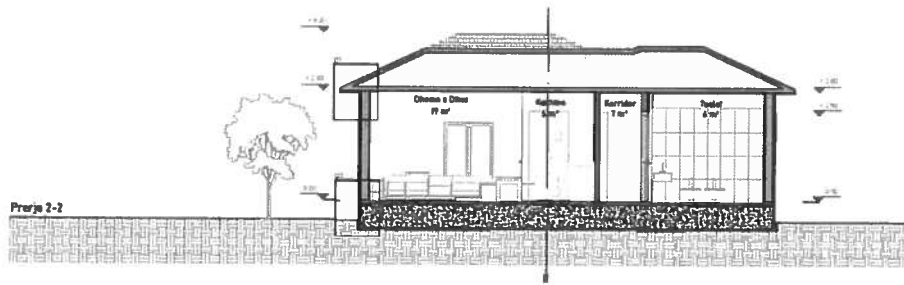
Planimetria e ndërtesave tip 3+1
